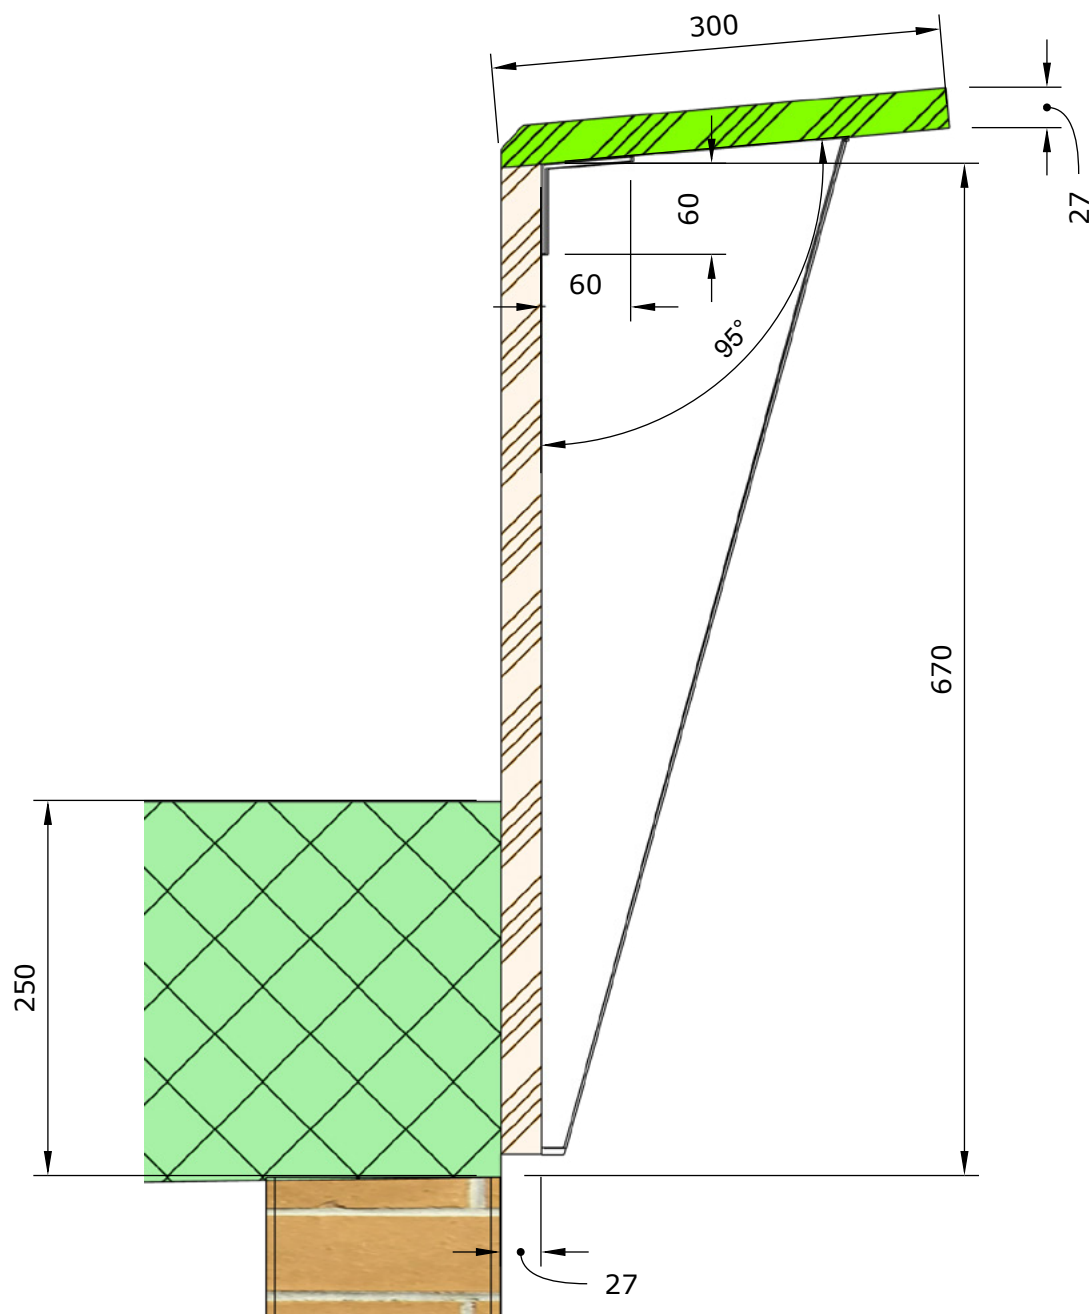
Vue en coupe, structure l'acrotère entièrement accessible avec tôle de support et cornière métallique $t = 2,0$ mm, dimensions en mm.
